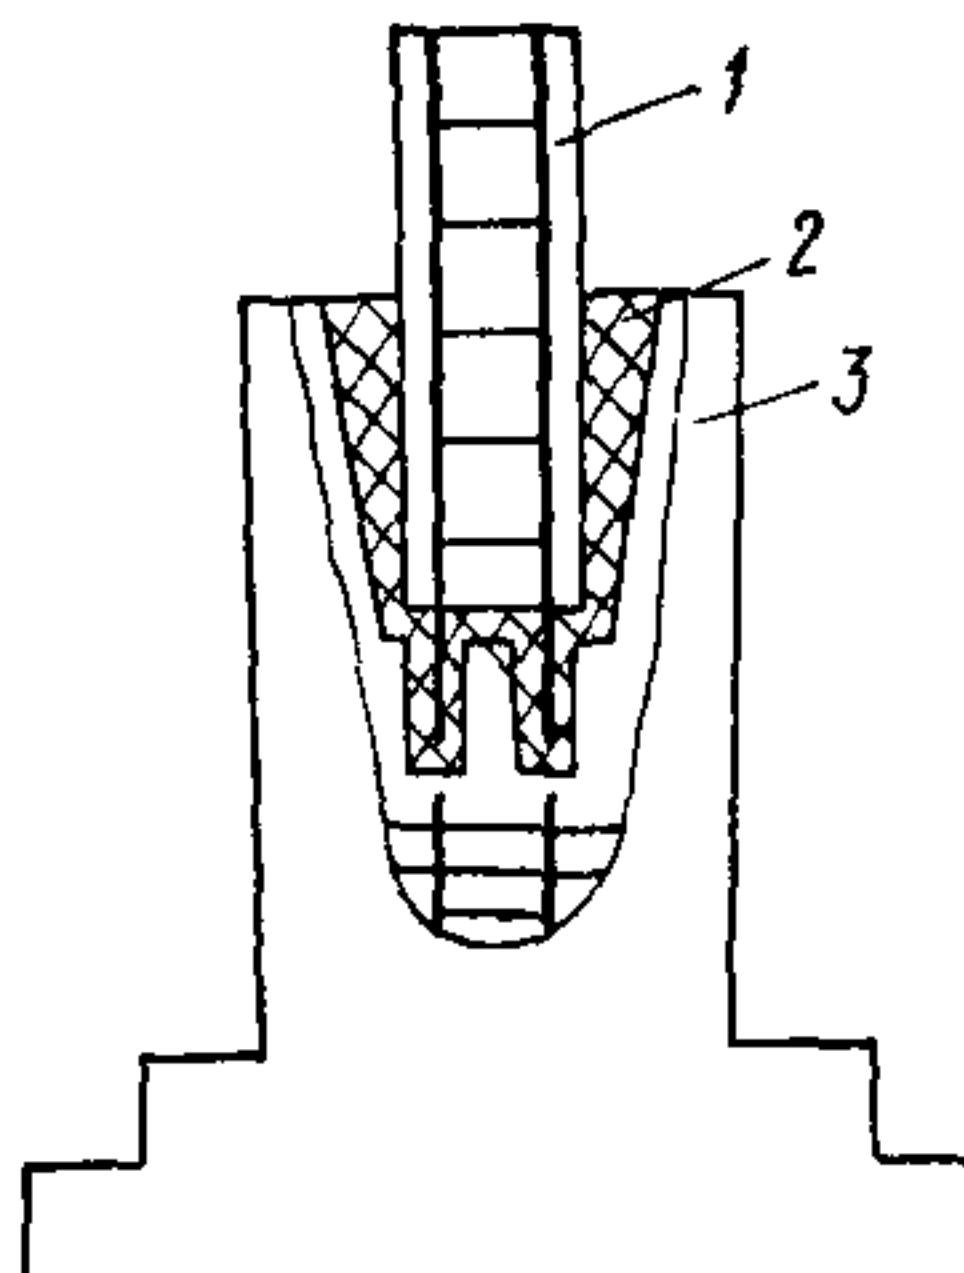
Пример kleевого соединения железобетонной колонны с фундаментом подвальных эстакад
